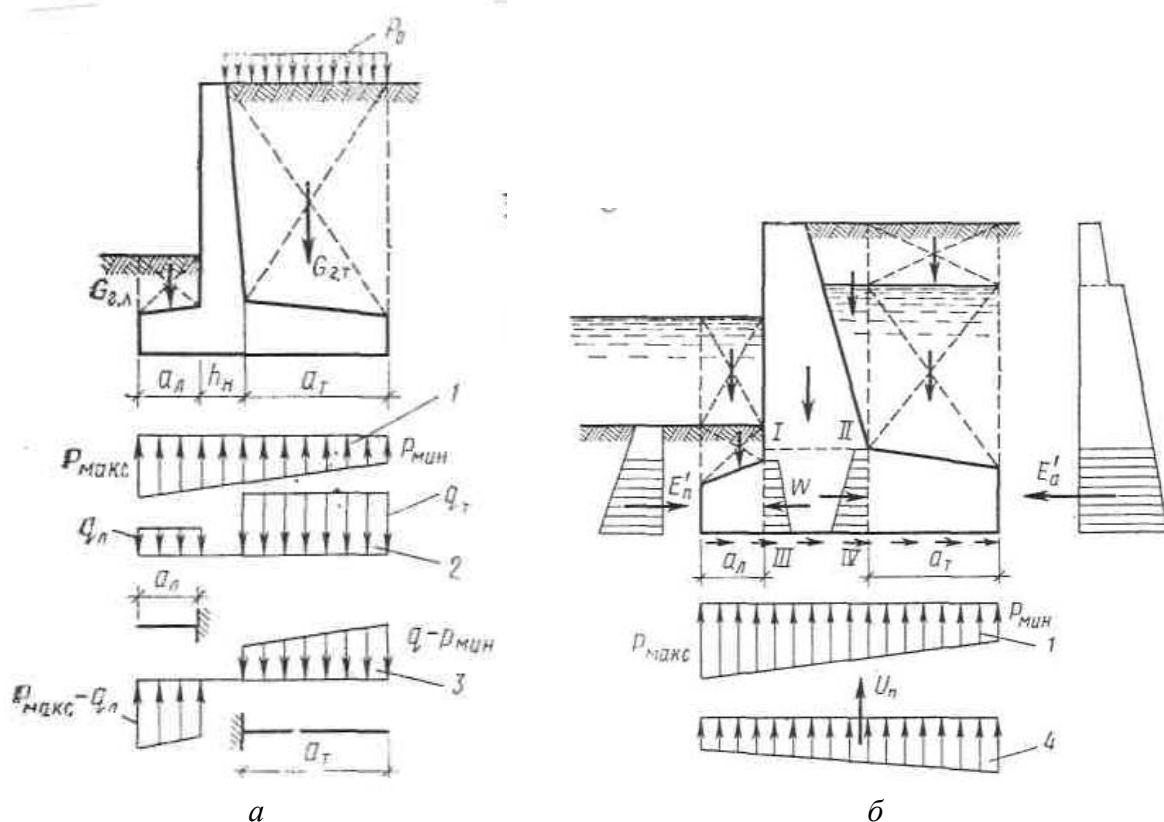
Схема к расчету фундаментной плиты облегченной (а) и массивной (б) подпорной стены: 1 – эпюра реактивного давления грунта; 2 – то же от нагрузок, расположенных над консолями; 3 – эпюра расчетных нагрузок; 4 – эпюра фильтрационного давления
